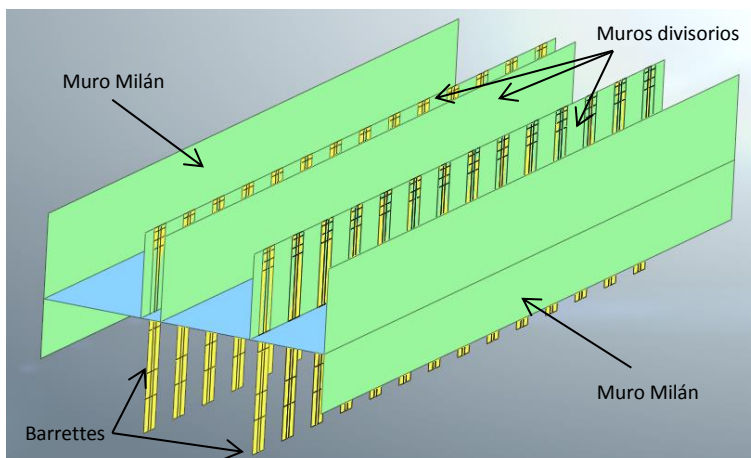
Creación de muros divisorios entre barretes y sobre la losa de fondo. Midas GTS NX.
